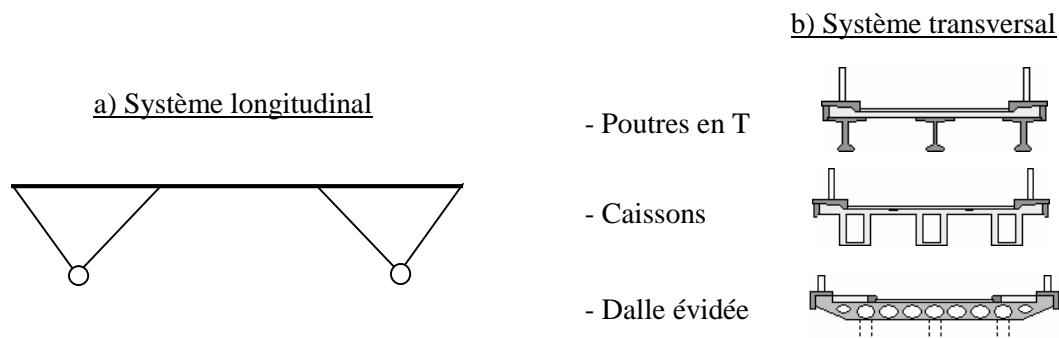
Pont à béquilles, système longitudinal et transversal.
